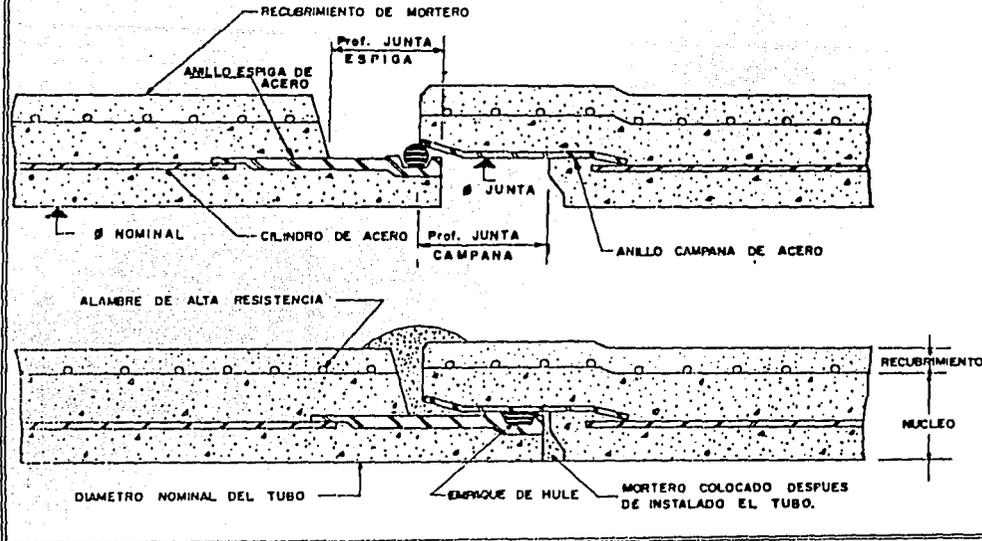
Detalle de una junta provista de un empaque de hule, en el cilindro de acero para un tubo.
